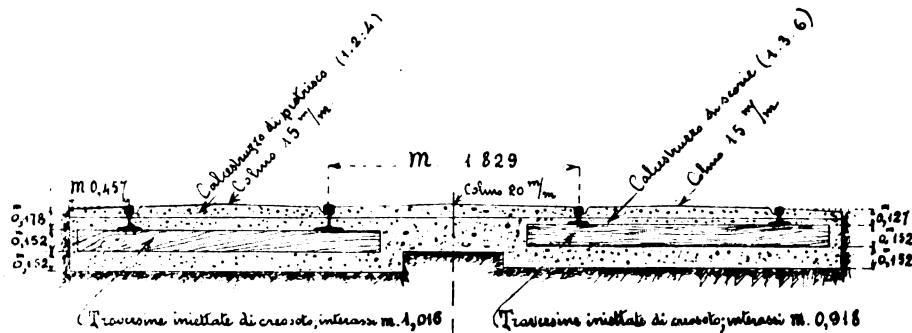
Sezione trasversale di una strada con pavimentazione in calcestruzzo a Birmingham.
